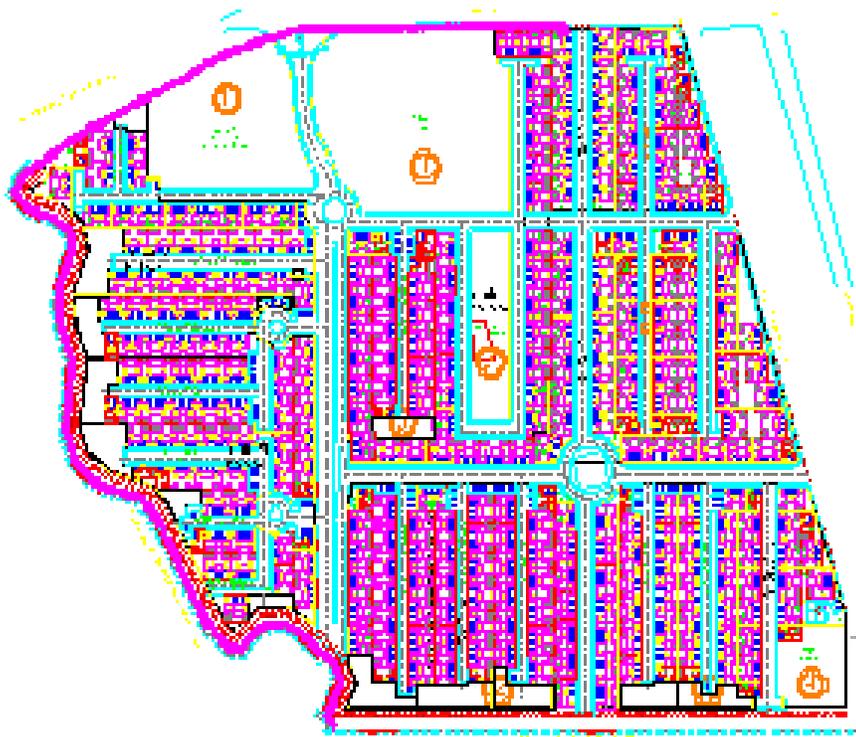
(a). Proyecto general de la obra “Los Portales”.
